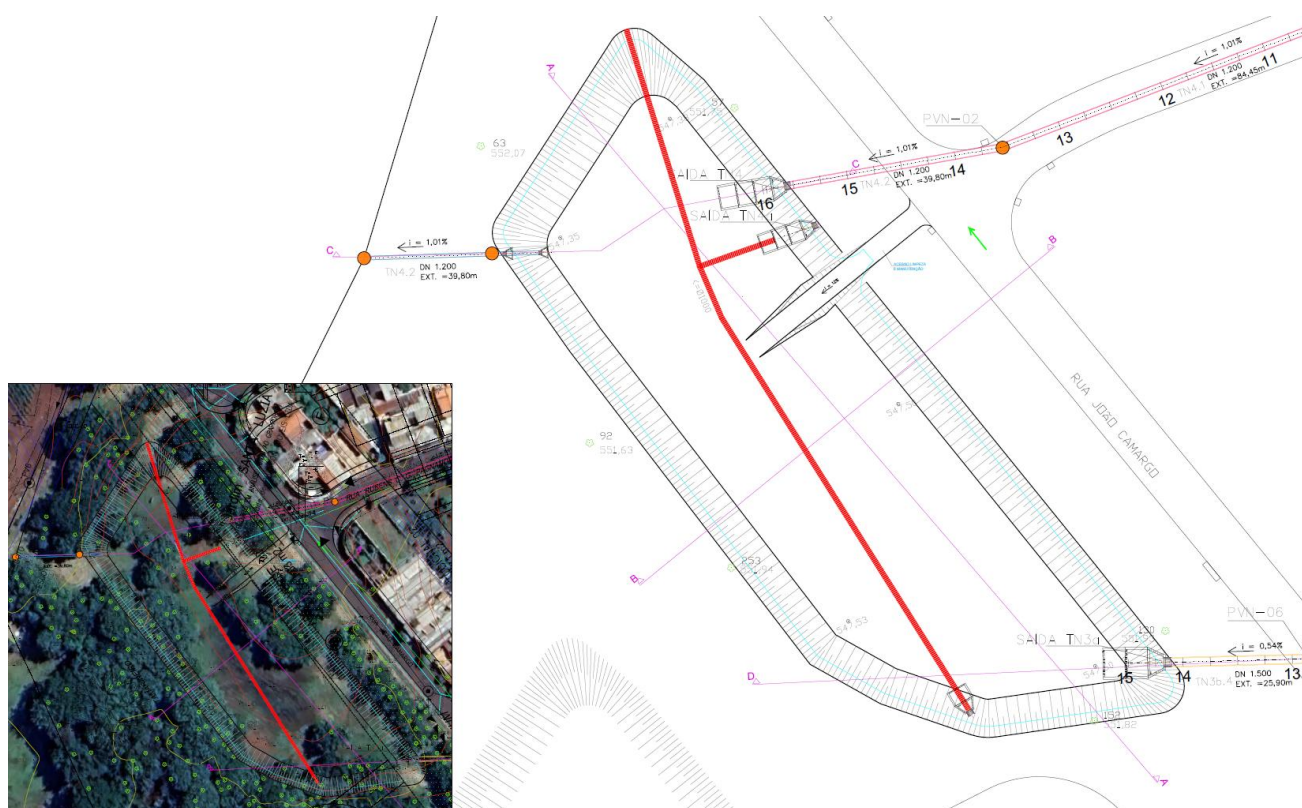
Planta da Bacia de Detenção de Cheias Projetada.
